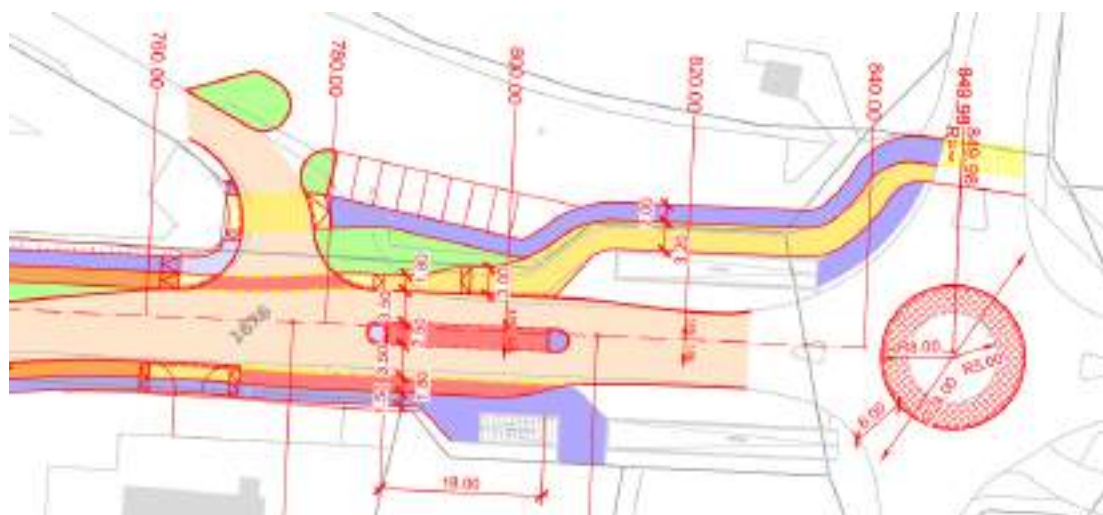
extrait en situation du carrefour ZI des Plavaux
